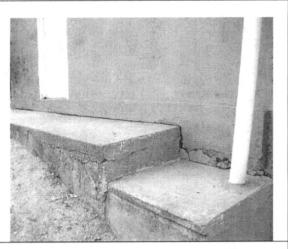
Se observan las fisuras existentes en la pared de la vivienda donde habita la Sra. Martha Lebró.
